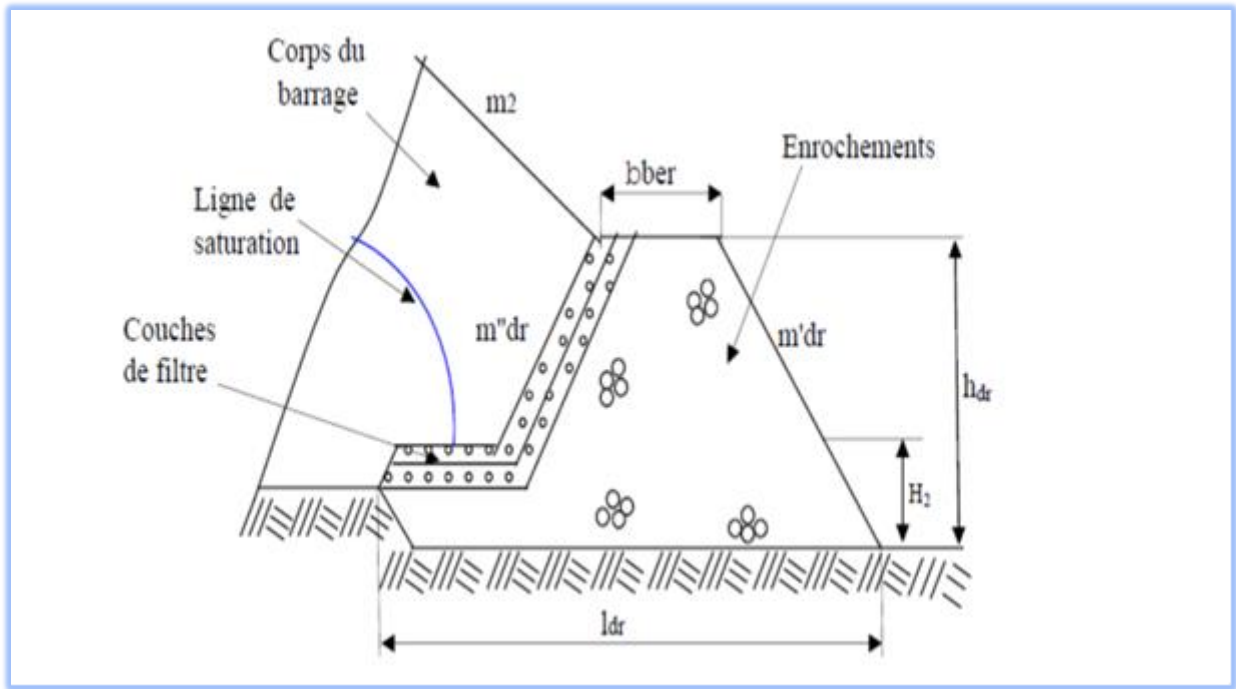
Prisme de drainage avec drain tapis interne sur fondations imperméable
